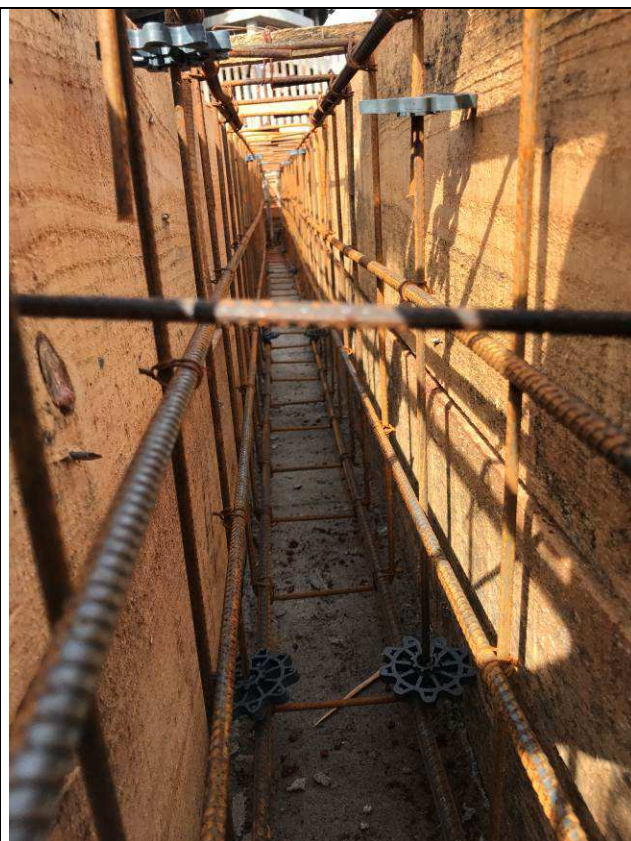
C: Formas e armaduras das vigas baldrames do prédio principal.
